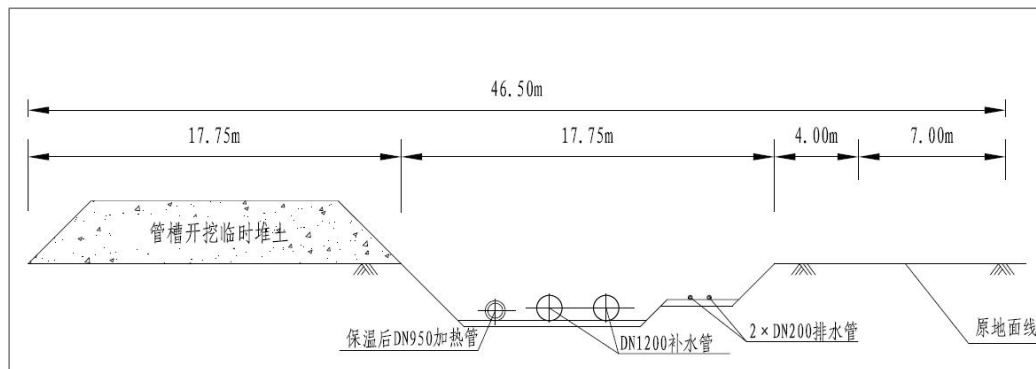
管线开挖作业宽度示意图 (单位 mm) (优化后)
